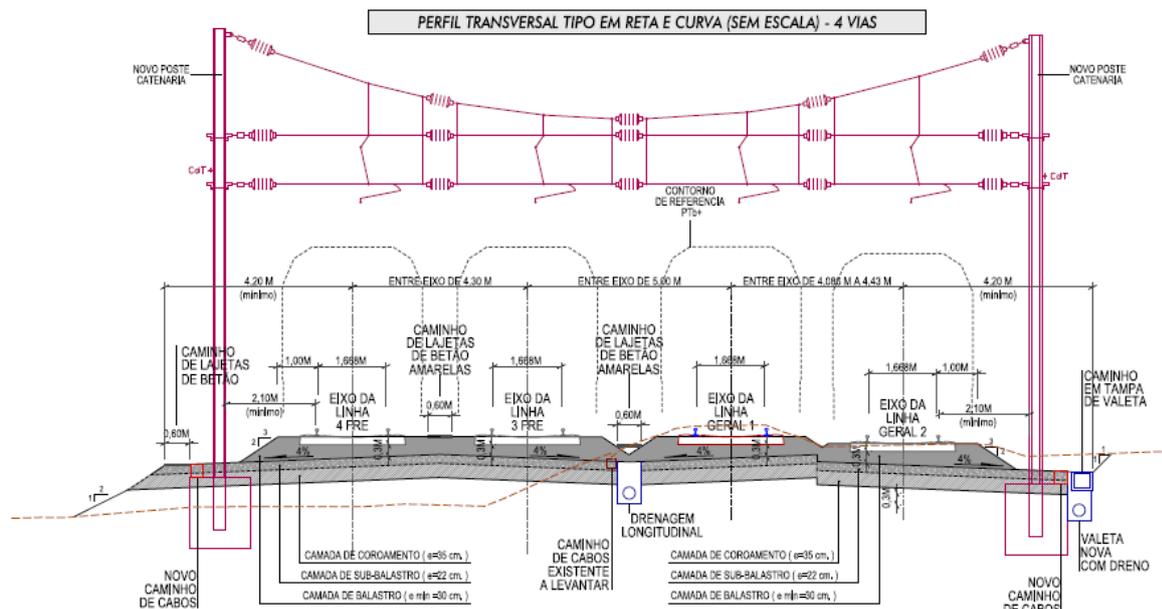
Corte Tipo – Terminal de Leixões – 4 vias
